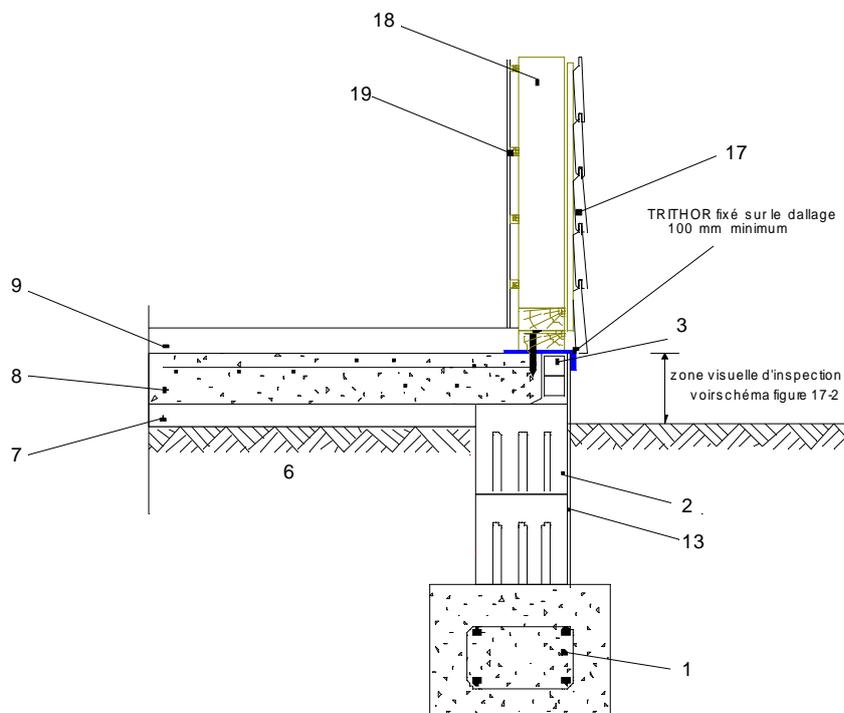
Bâtiment en ossature bois – Sur dallage avec planelle périmétrique (voir détail Figure 11-2 et Figure 12)
